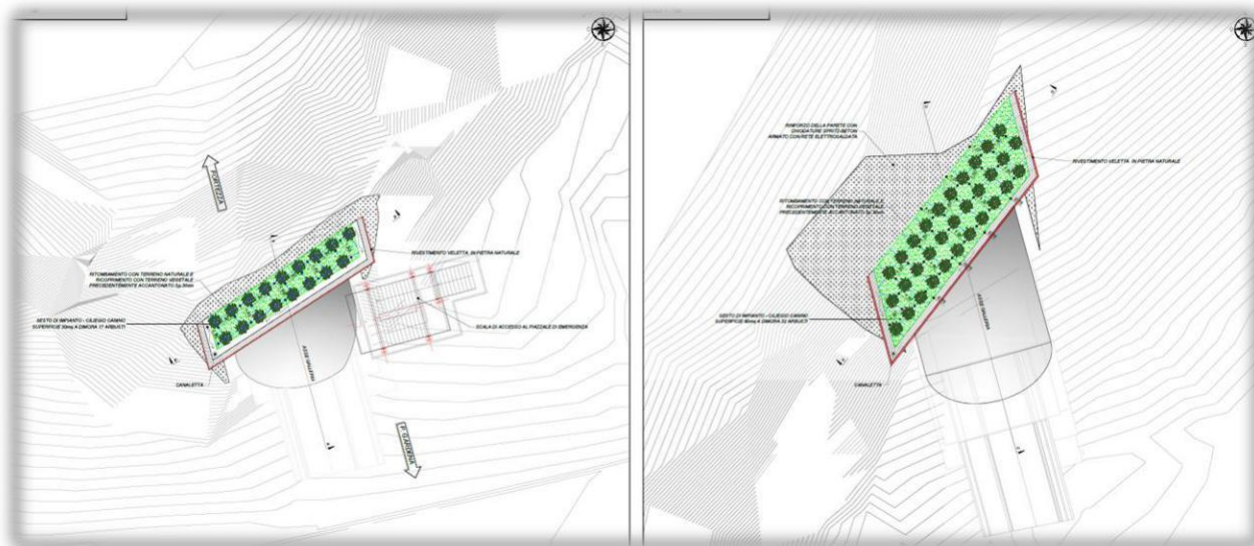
Opere a verde – Planimetria di progetto imbocco Galleria Scaleres – Imbocco Sud.
